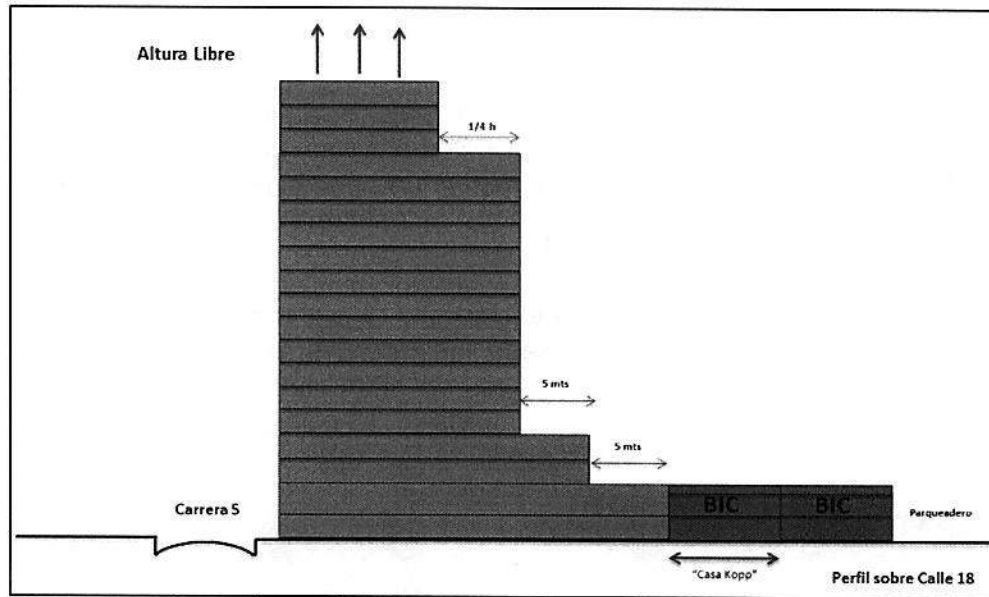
Perfil sobre la calle 18, fuente: IDPC 2017
